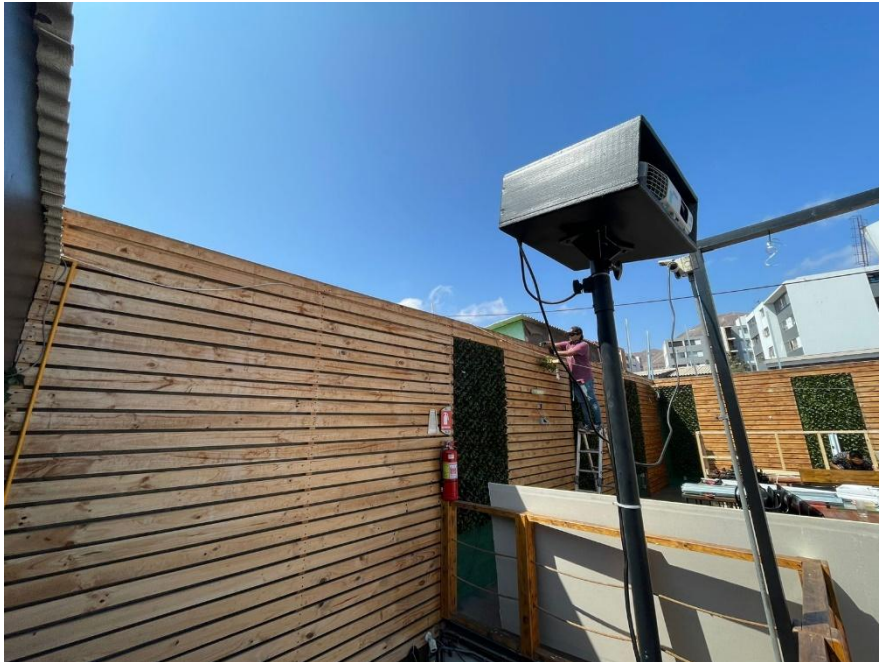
Vista avance levantamiento estructura murallas este y sur
